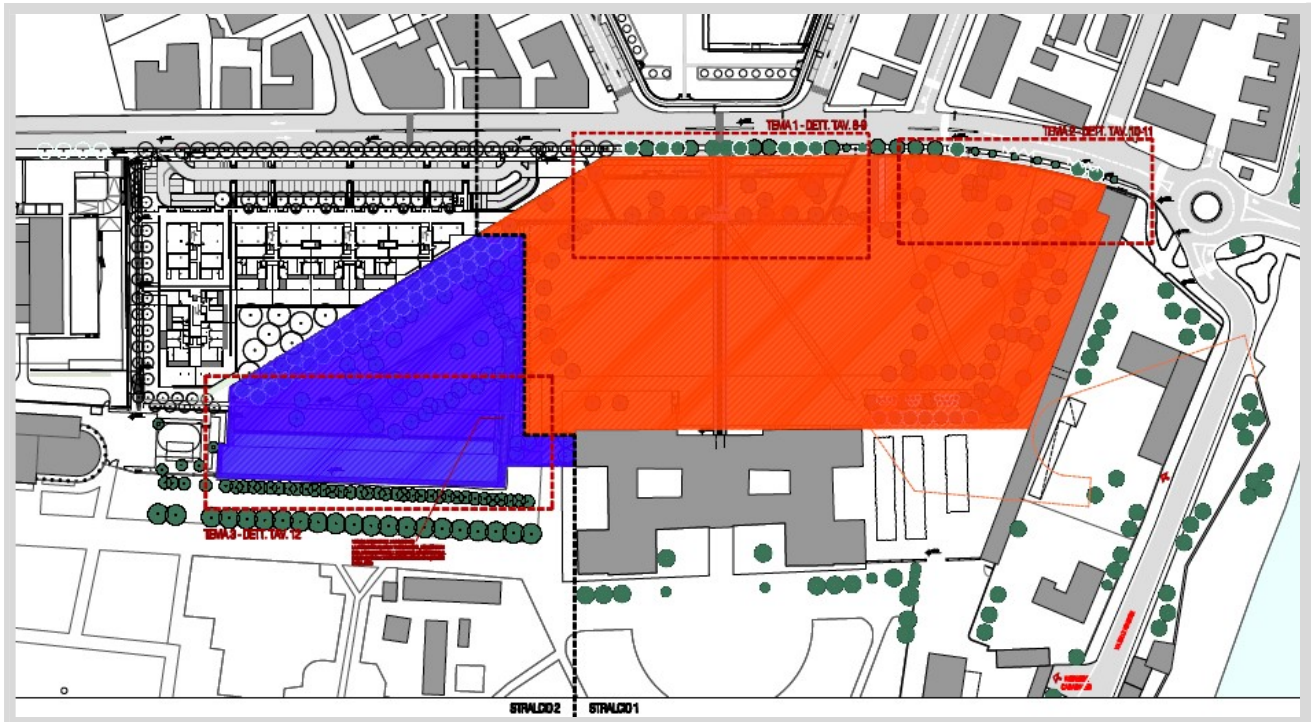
Suddivisione in stralci: in rosso il Primo stralcio già ultimato e in blu il Secondo stralcio, in progettazione
